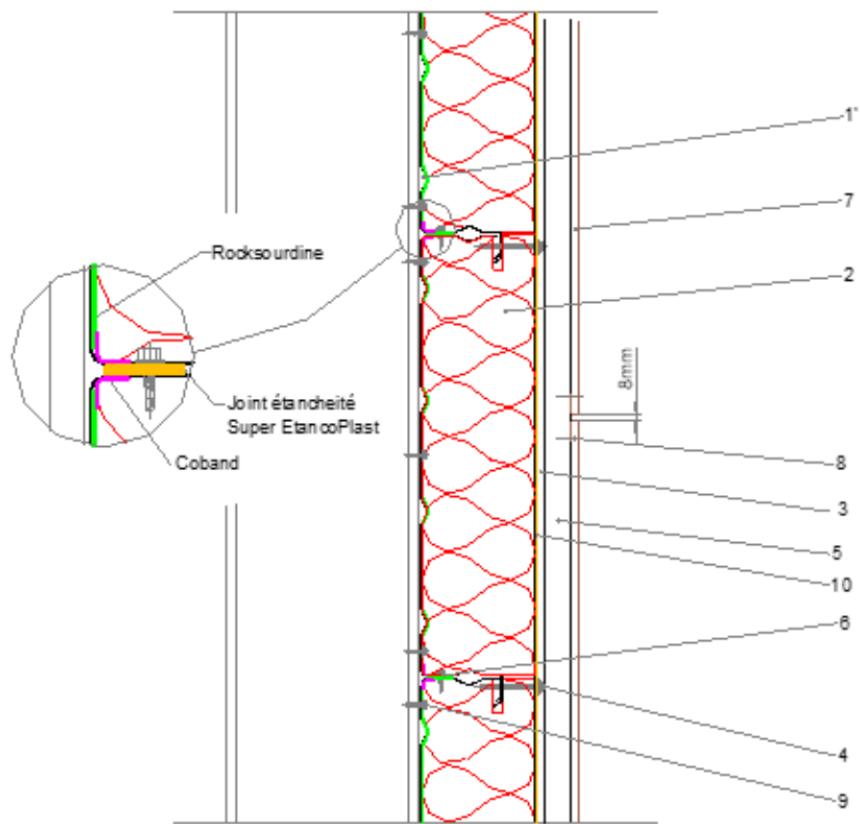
Coupe verticale en partie courante (avec Rockourdine sur plateaux perforés)
